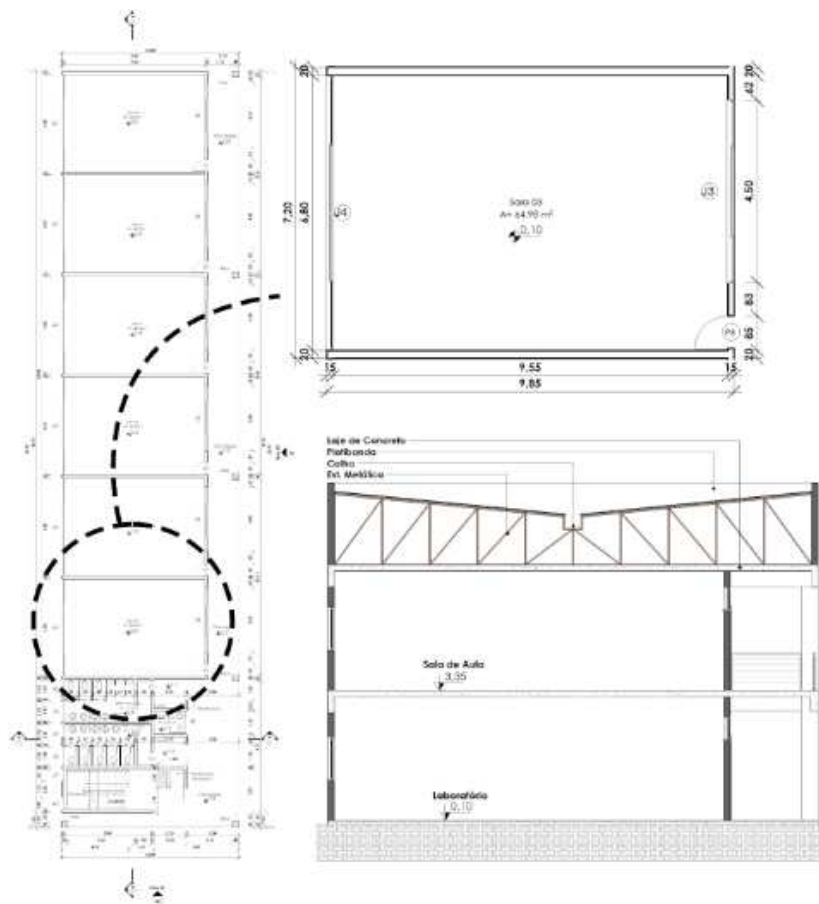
(a) Planta Baixa; Figura 2(b) Planta da Sala de Aula; Figura 2(c) Corte Existente.
